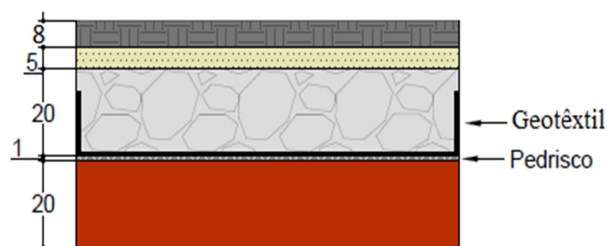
Esquematização das camadas da estrutura do terceiro ensaio em centímetros.
